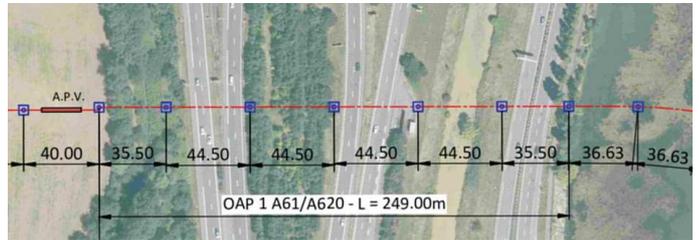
Vue en plan et implantation des piles de l'ouvrage particulier de franchissement de l'A61/A620/RD916 -
